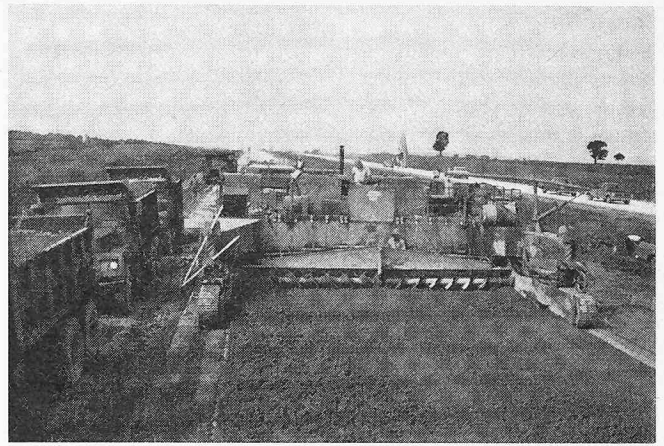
Eine zweite, die Betonierung beendende Maschine folgt der ersten, gleicht den Beton aus und sorgt für eine ebene kompakte Betonoberfläche mit Hilfe von vibrierenden «finishing»-Platten. Auf der linken Seite sieht man hintereinander wartende Beton-«Trucks» (Beton-Zufuhrlastwagen), um Maschine 1 gemäss Bild 3 unterbruchslos zu beliefern. Je Stunde werden rd. 600 cu yards (rd. 460 m<sup>3</sup>) Beton verarbeitet
